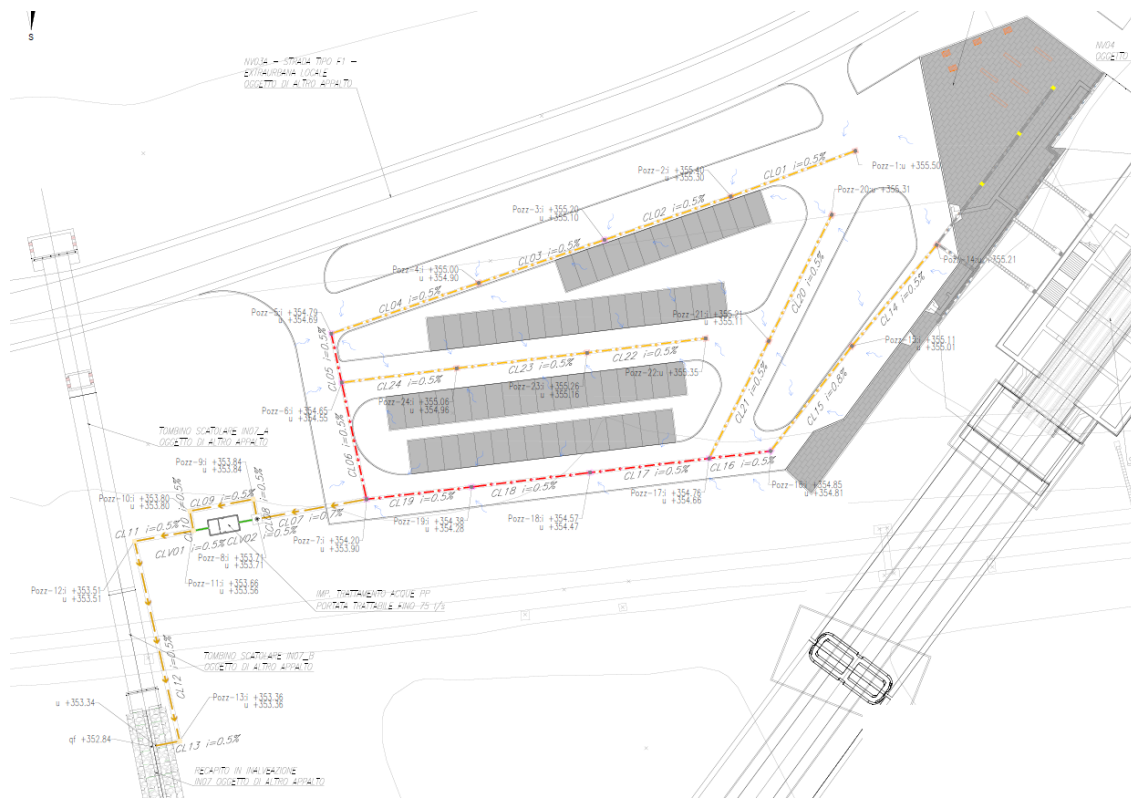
Stralcio planimetrico Rete di drenaggio parcheggio stazione di Orsara
